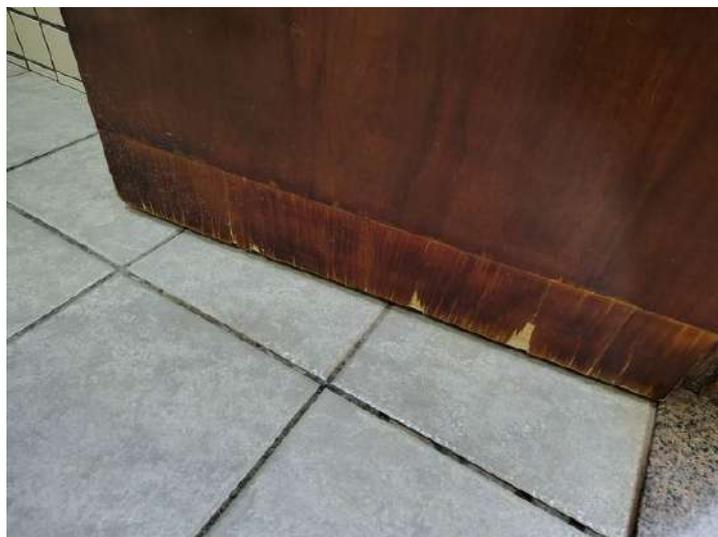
WC Masculino – Deterioração da porta de madeira
